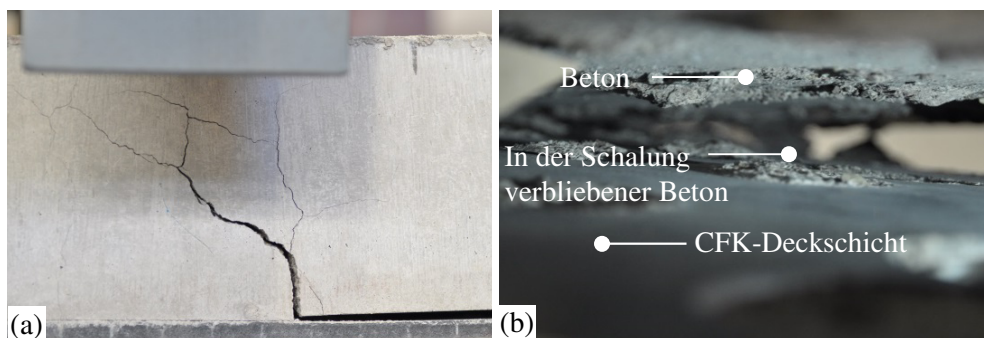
Versagensmechanismus der Probekörper durch Betonschub: (a) abgeschlossenes Rissbild unterhalb der Lasteinleitung; (b) Nahaufnahme zwischen Beton und SVS
